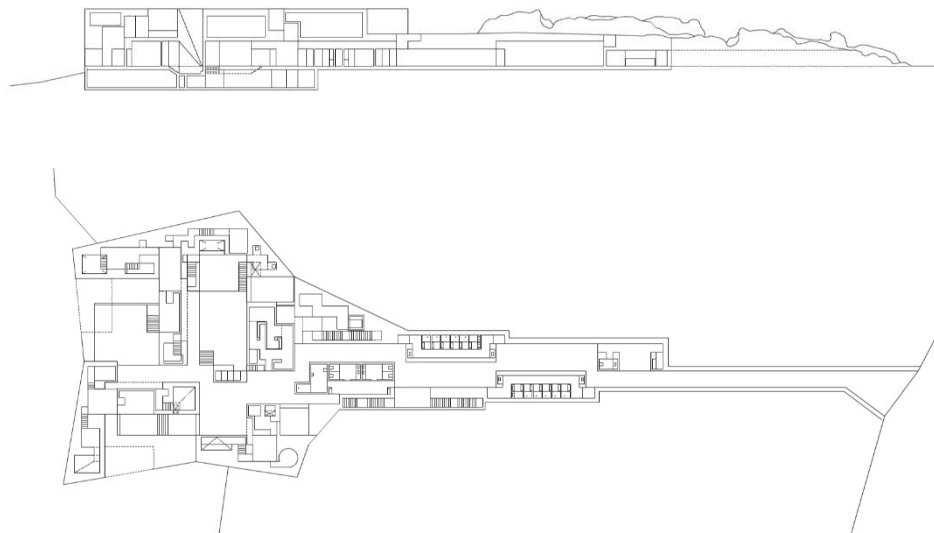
y 42: Termas en Serra da Estrela. Sección longitudinal y planta principal. Aires Mateus.
